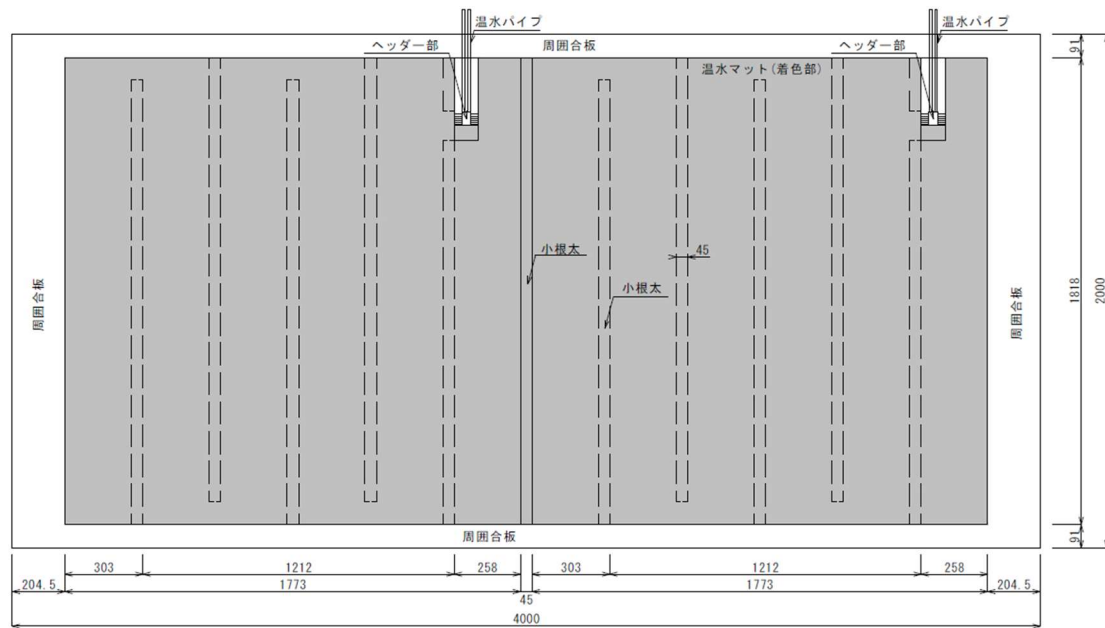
試験体図(温水マット配置図、施工時に確認) 単位 : mm
